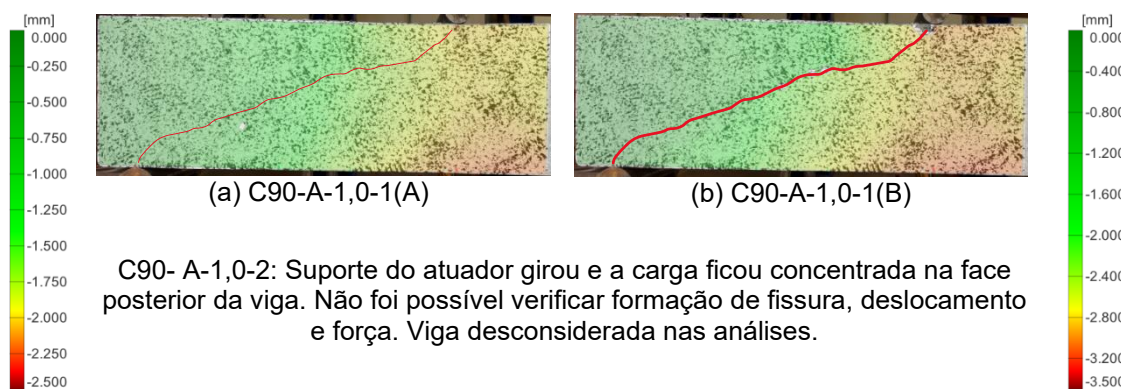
Formação da fissura diagonal - Vigas C90-A-1,0
